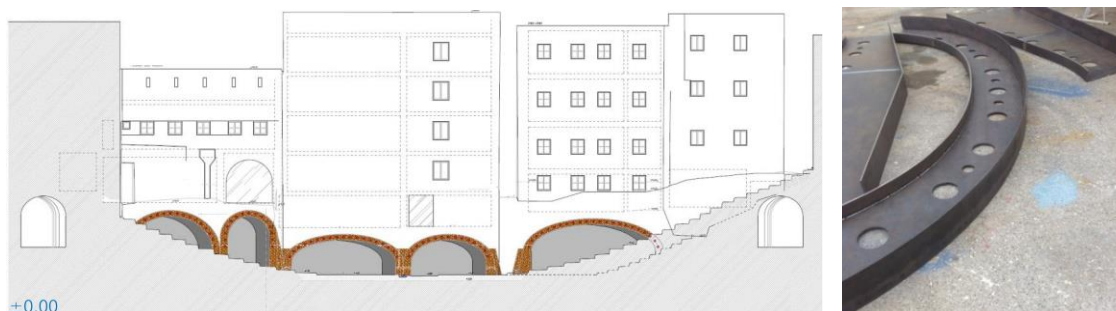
a) Alzado esquemático tras la extracción de tierras. b) Arcos de acero.
